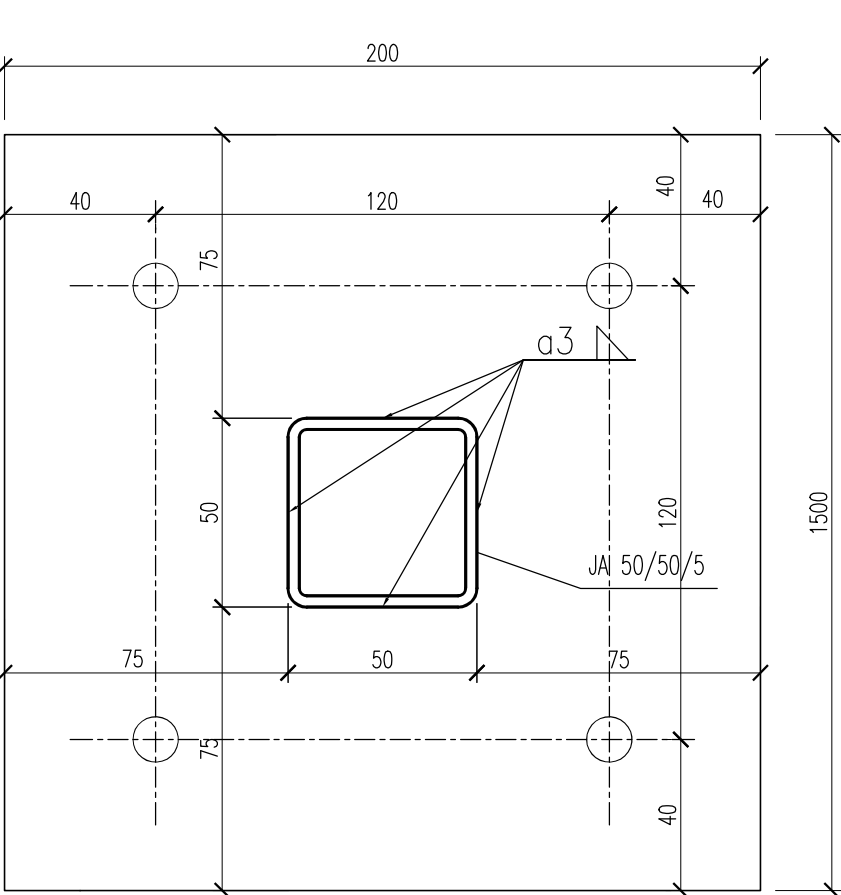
DETAIL NAPOJENÍ NA SLOUPEK ZASTŘEŠENÍ
